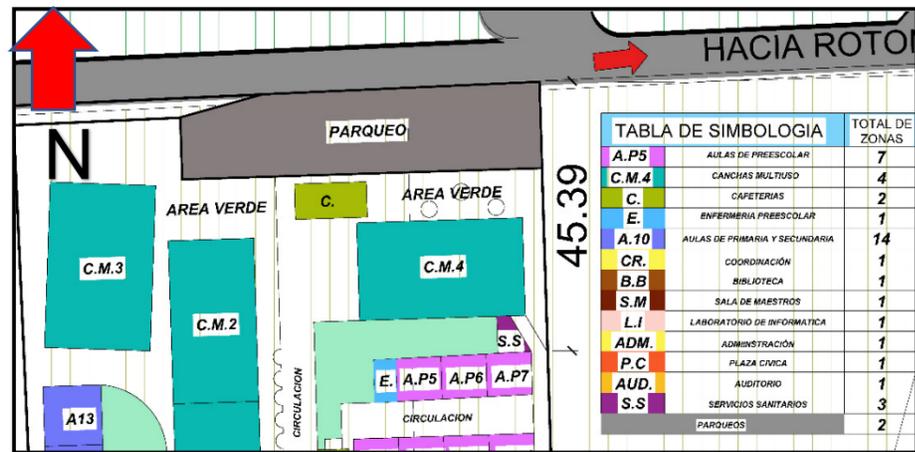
Zonificación retiros existentes de las aulas de preescolar con la pista suburbana "aproximación" Fuente: Autores
